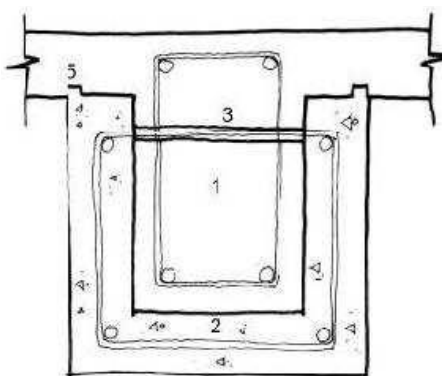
Renforcement par ajout d'armature (chemisage)
